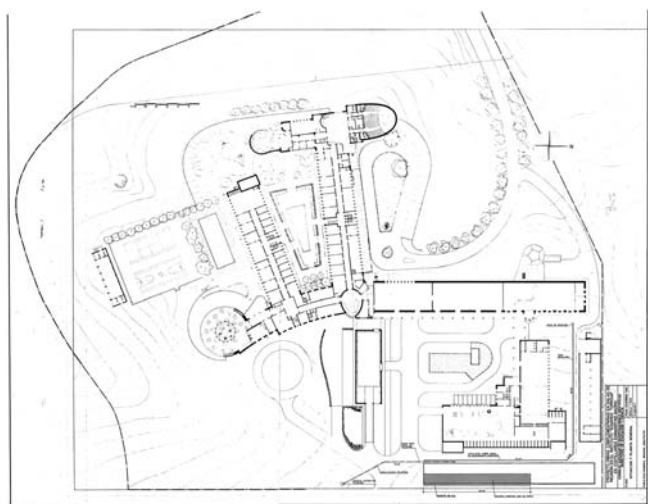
Planta baja del IETCC. (Archivo del IETCC).
